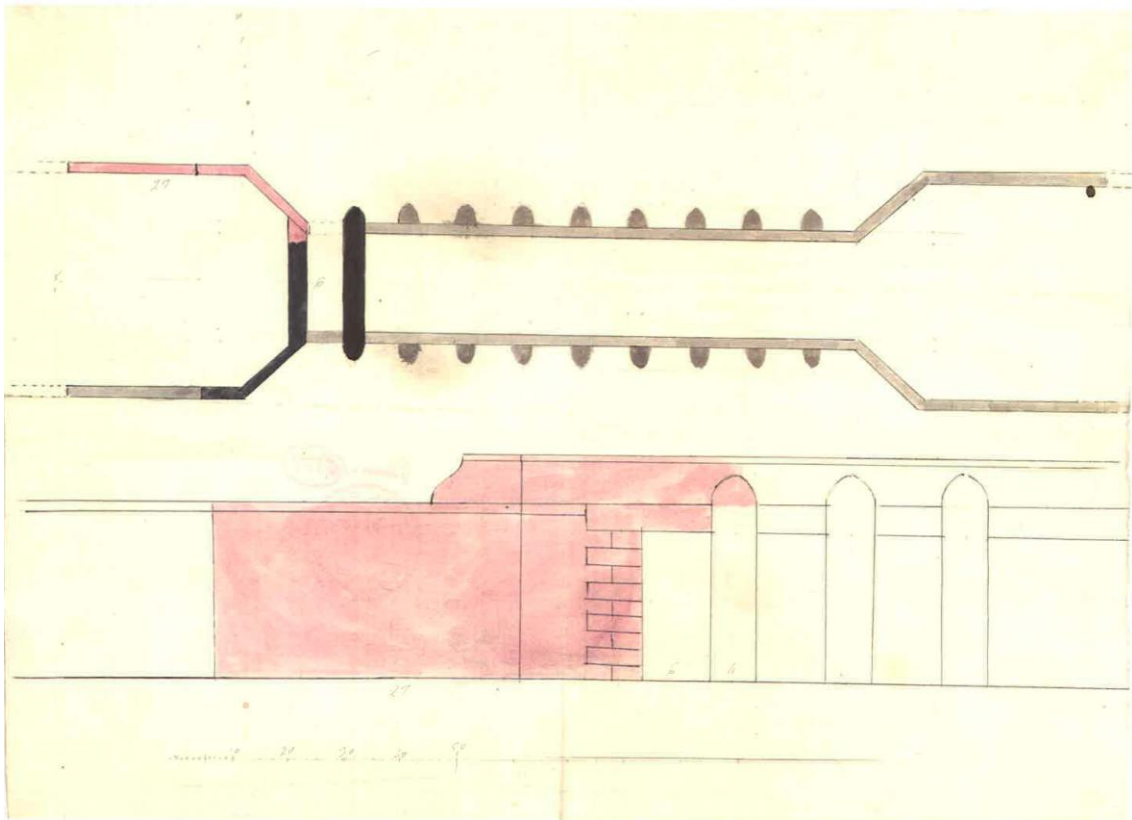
Puente de Tejada en el Real Sitio de El Pardo. Planta y alzado.
